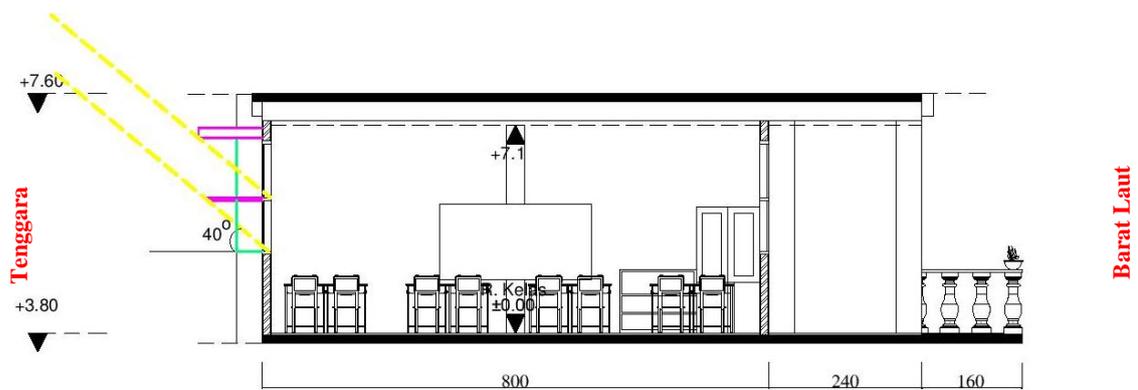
Tampak Tenggara dan Barat Laut Ruang Alternatif 1 Rekomendasi Eksternal II
